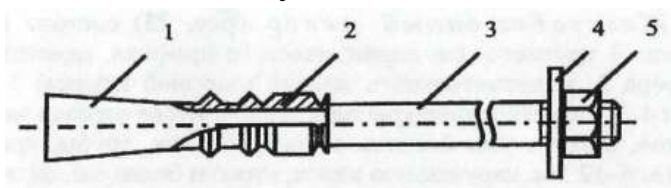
Конструкция металлического клинораспорного анкера ШК-1М
